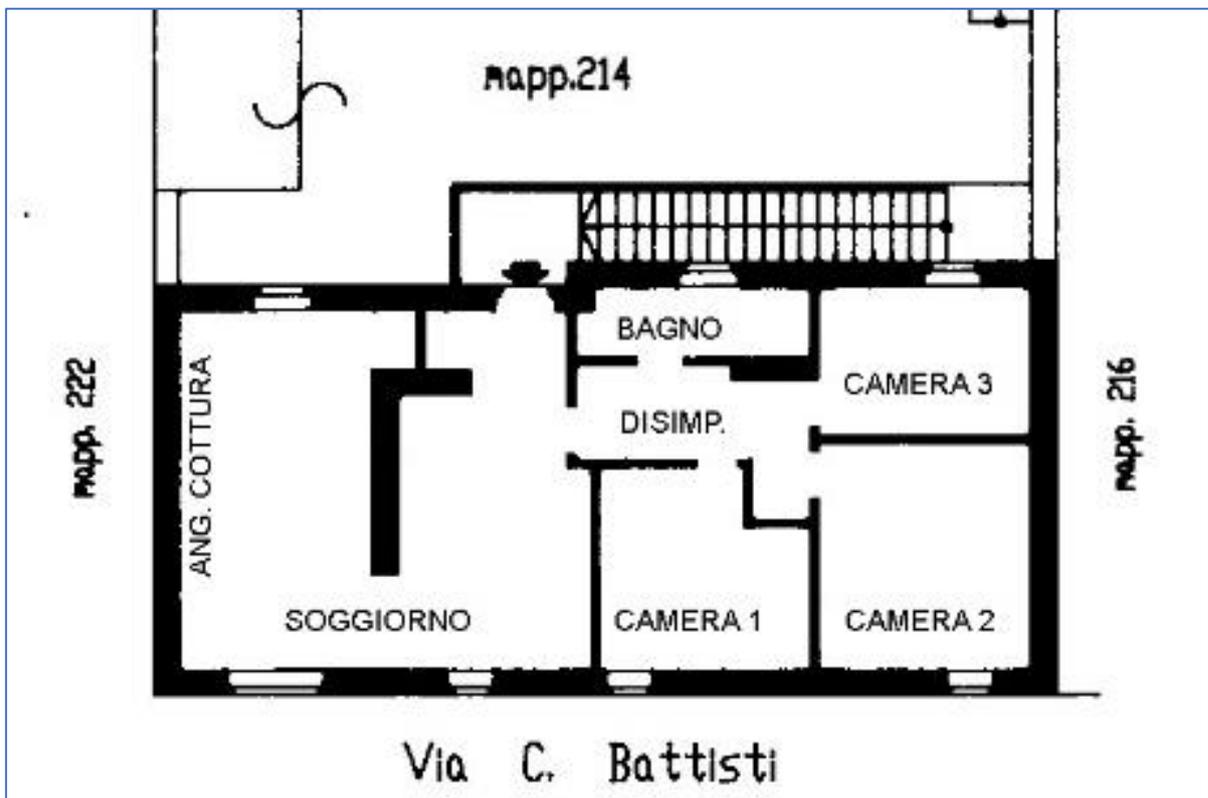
Schema planimetrico rilevato sulla base della planimetria catastale
